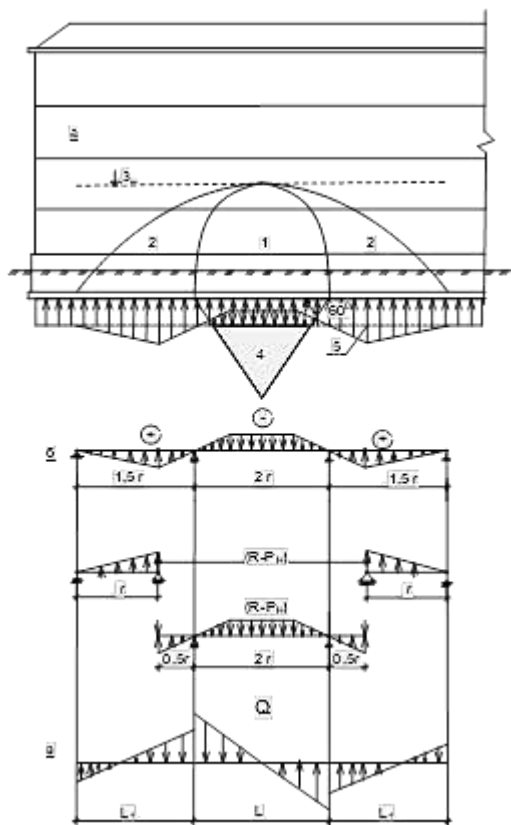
Розрахункова схема зовнішньої стіни: а) фрагмент фасаду; б) розрахункова схема зовнішньої стінки. Балка Гербера; в) епюра зсувних сил Q ; 1 – параболічний звід навантаження; 2 – параболічне склепіння деформацій та пошкоджень кладки стіни; 3 – нульовий обрій активних деформацій кладки стіни; 4 – конус замочування просадного ґрунту; 5 – епюра рівноваги всіх сил.
